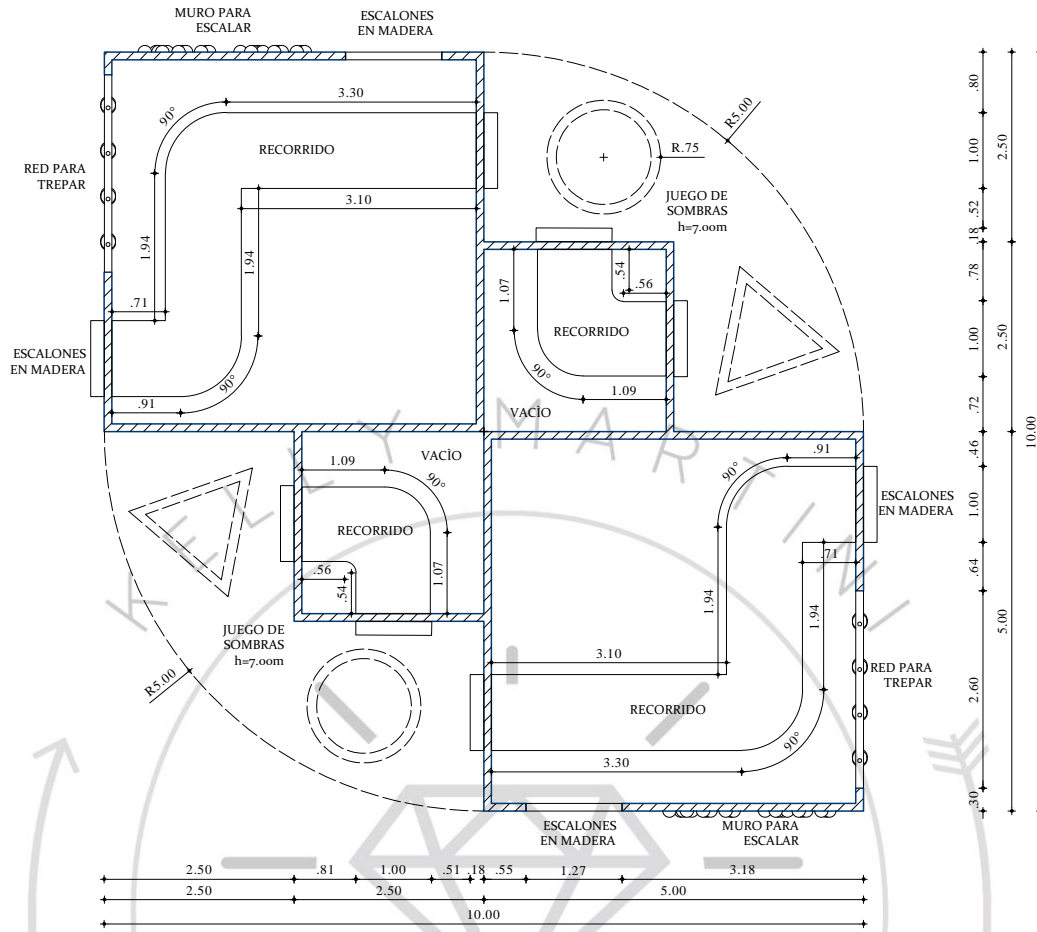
Primera Planta Folie 01. Por Kelly Vanegas
